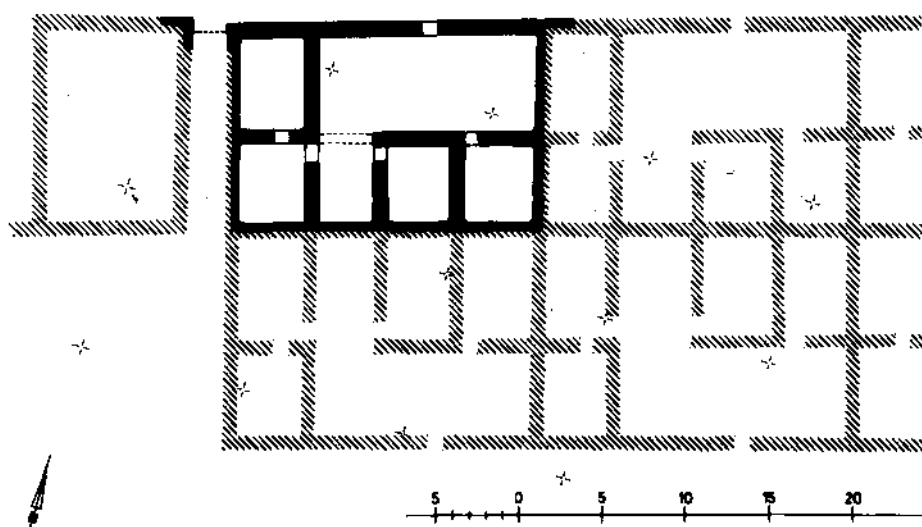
Bautyp Hofhaus im Abschnitt M 12, schematischer Plan (Norden ist oben)
